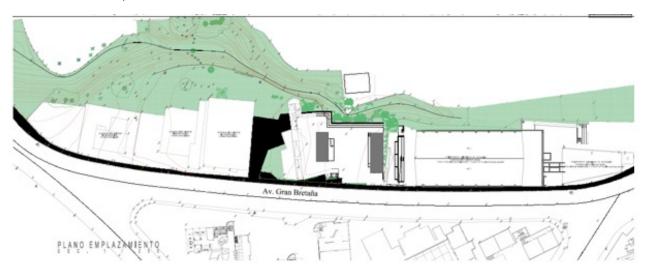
Planta del proyecto. Fuente: Elaboración propia
